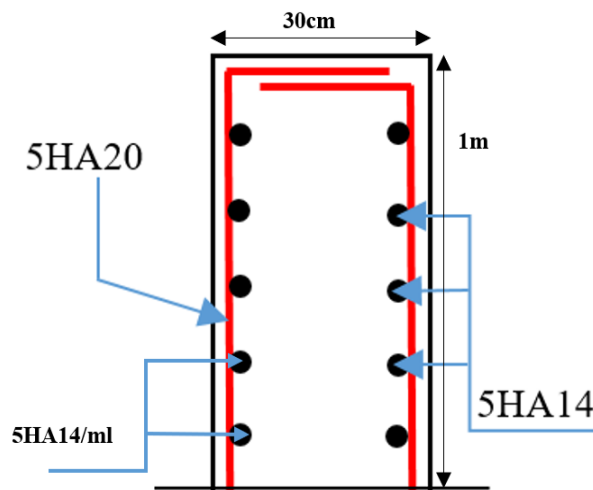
FERRAILLAGE DU MUR GARDE GRAVE
